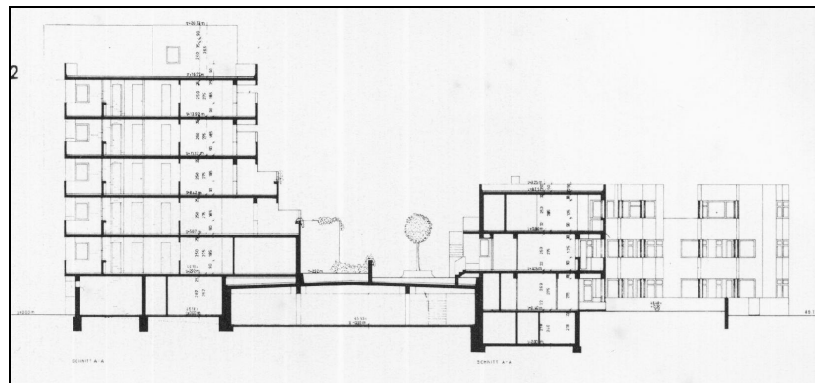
Projeto de Boehm. "Conjunto residencial en Köln-Chorweiler", Alemanha. CORTE
